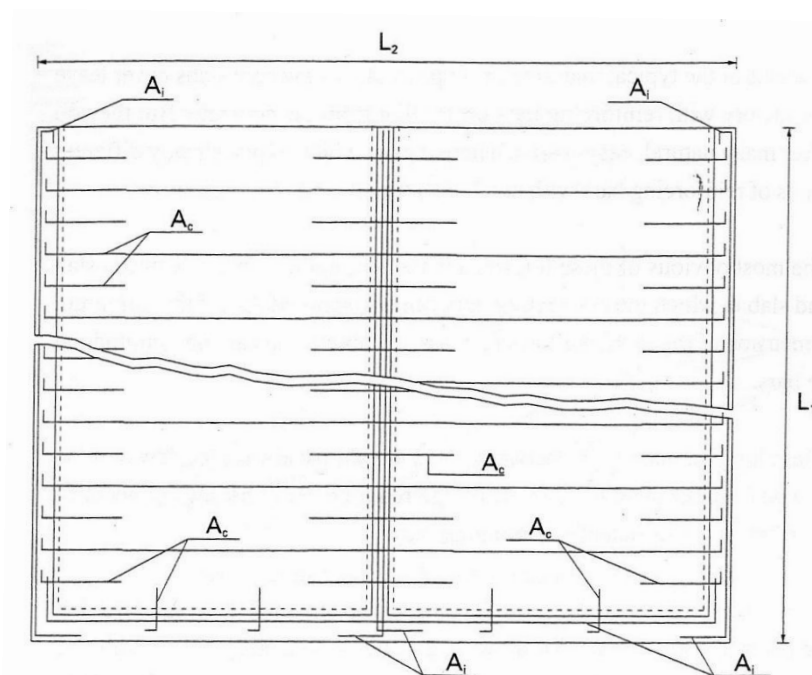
1 – Possíveis conexões existentes em um pavimento com laje alveolar sem capa (FONTE: Manual ASSAP, 2002)
